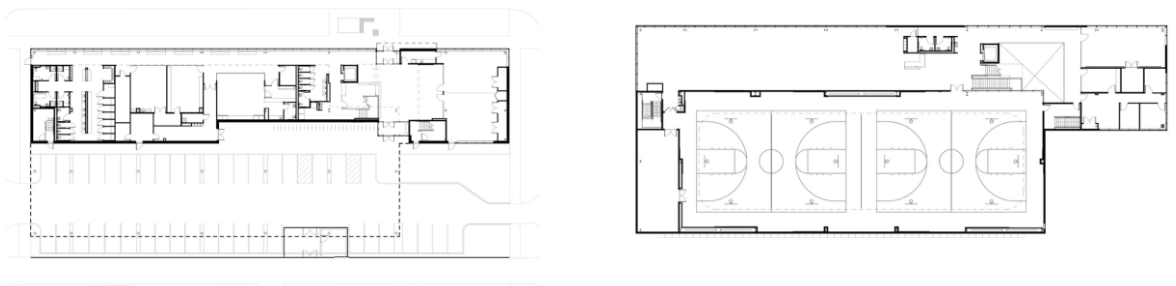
Планування 1-го та 2-го поверху будівлі
